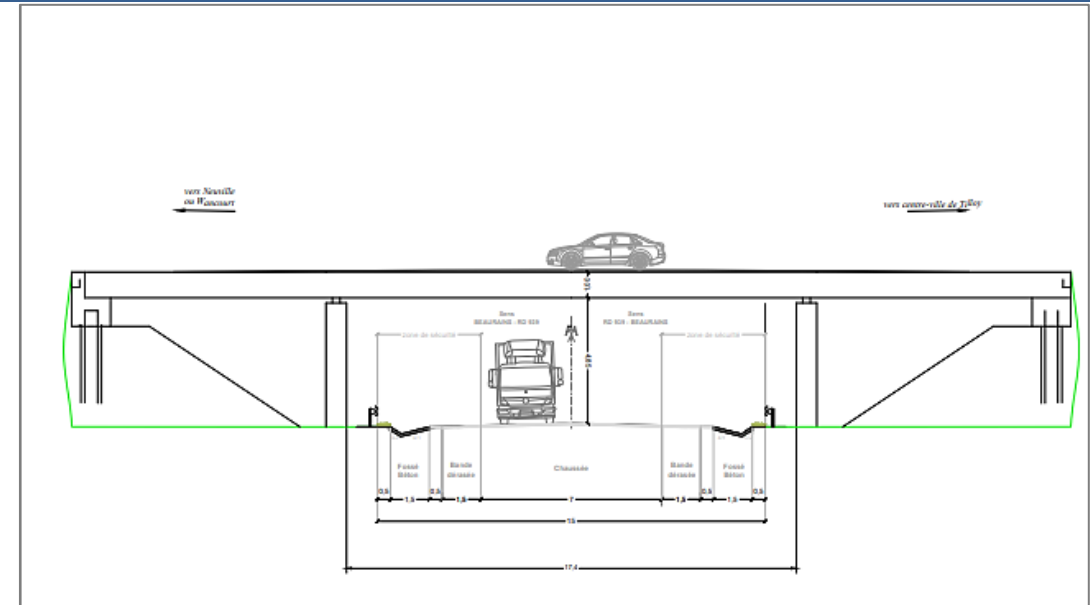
Profil en travers du futur contournement routier sous les ouvrages d'art de la rue de Neuville et de la RD37E1
